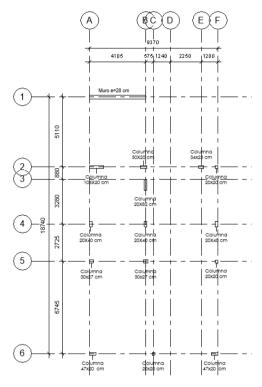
Ubicación de elementos verticales en la primera planta (Proaño G.,2021).
